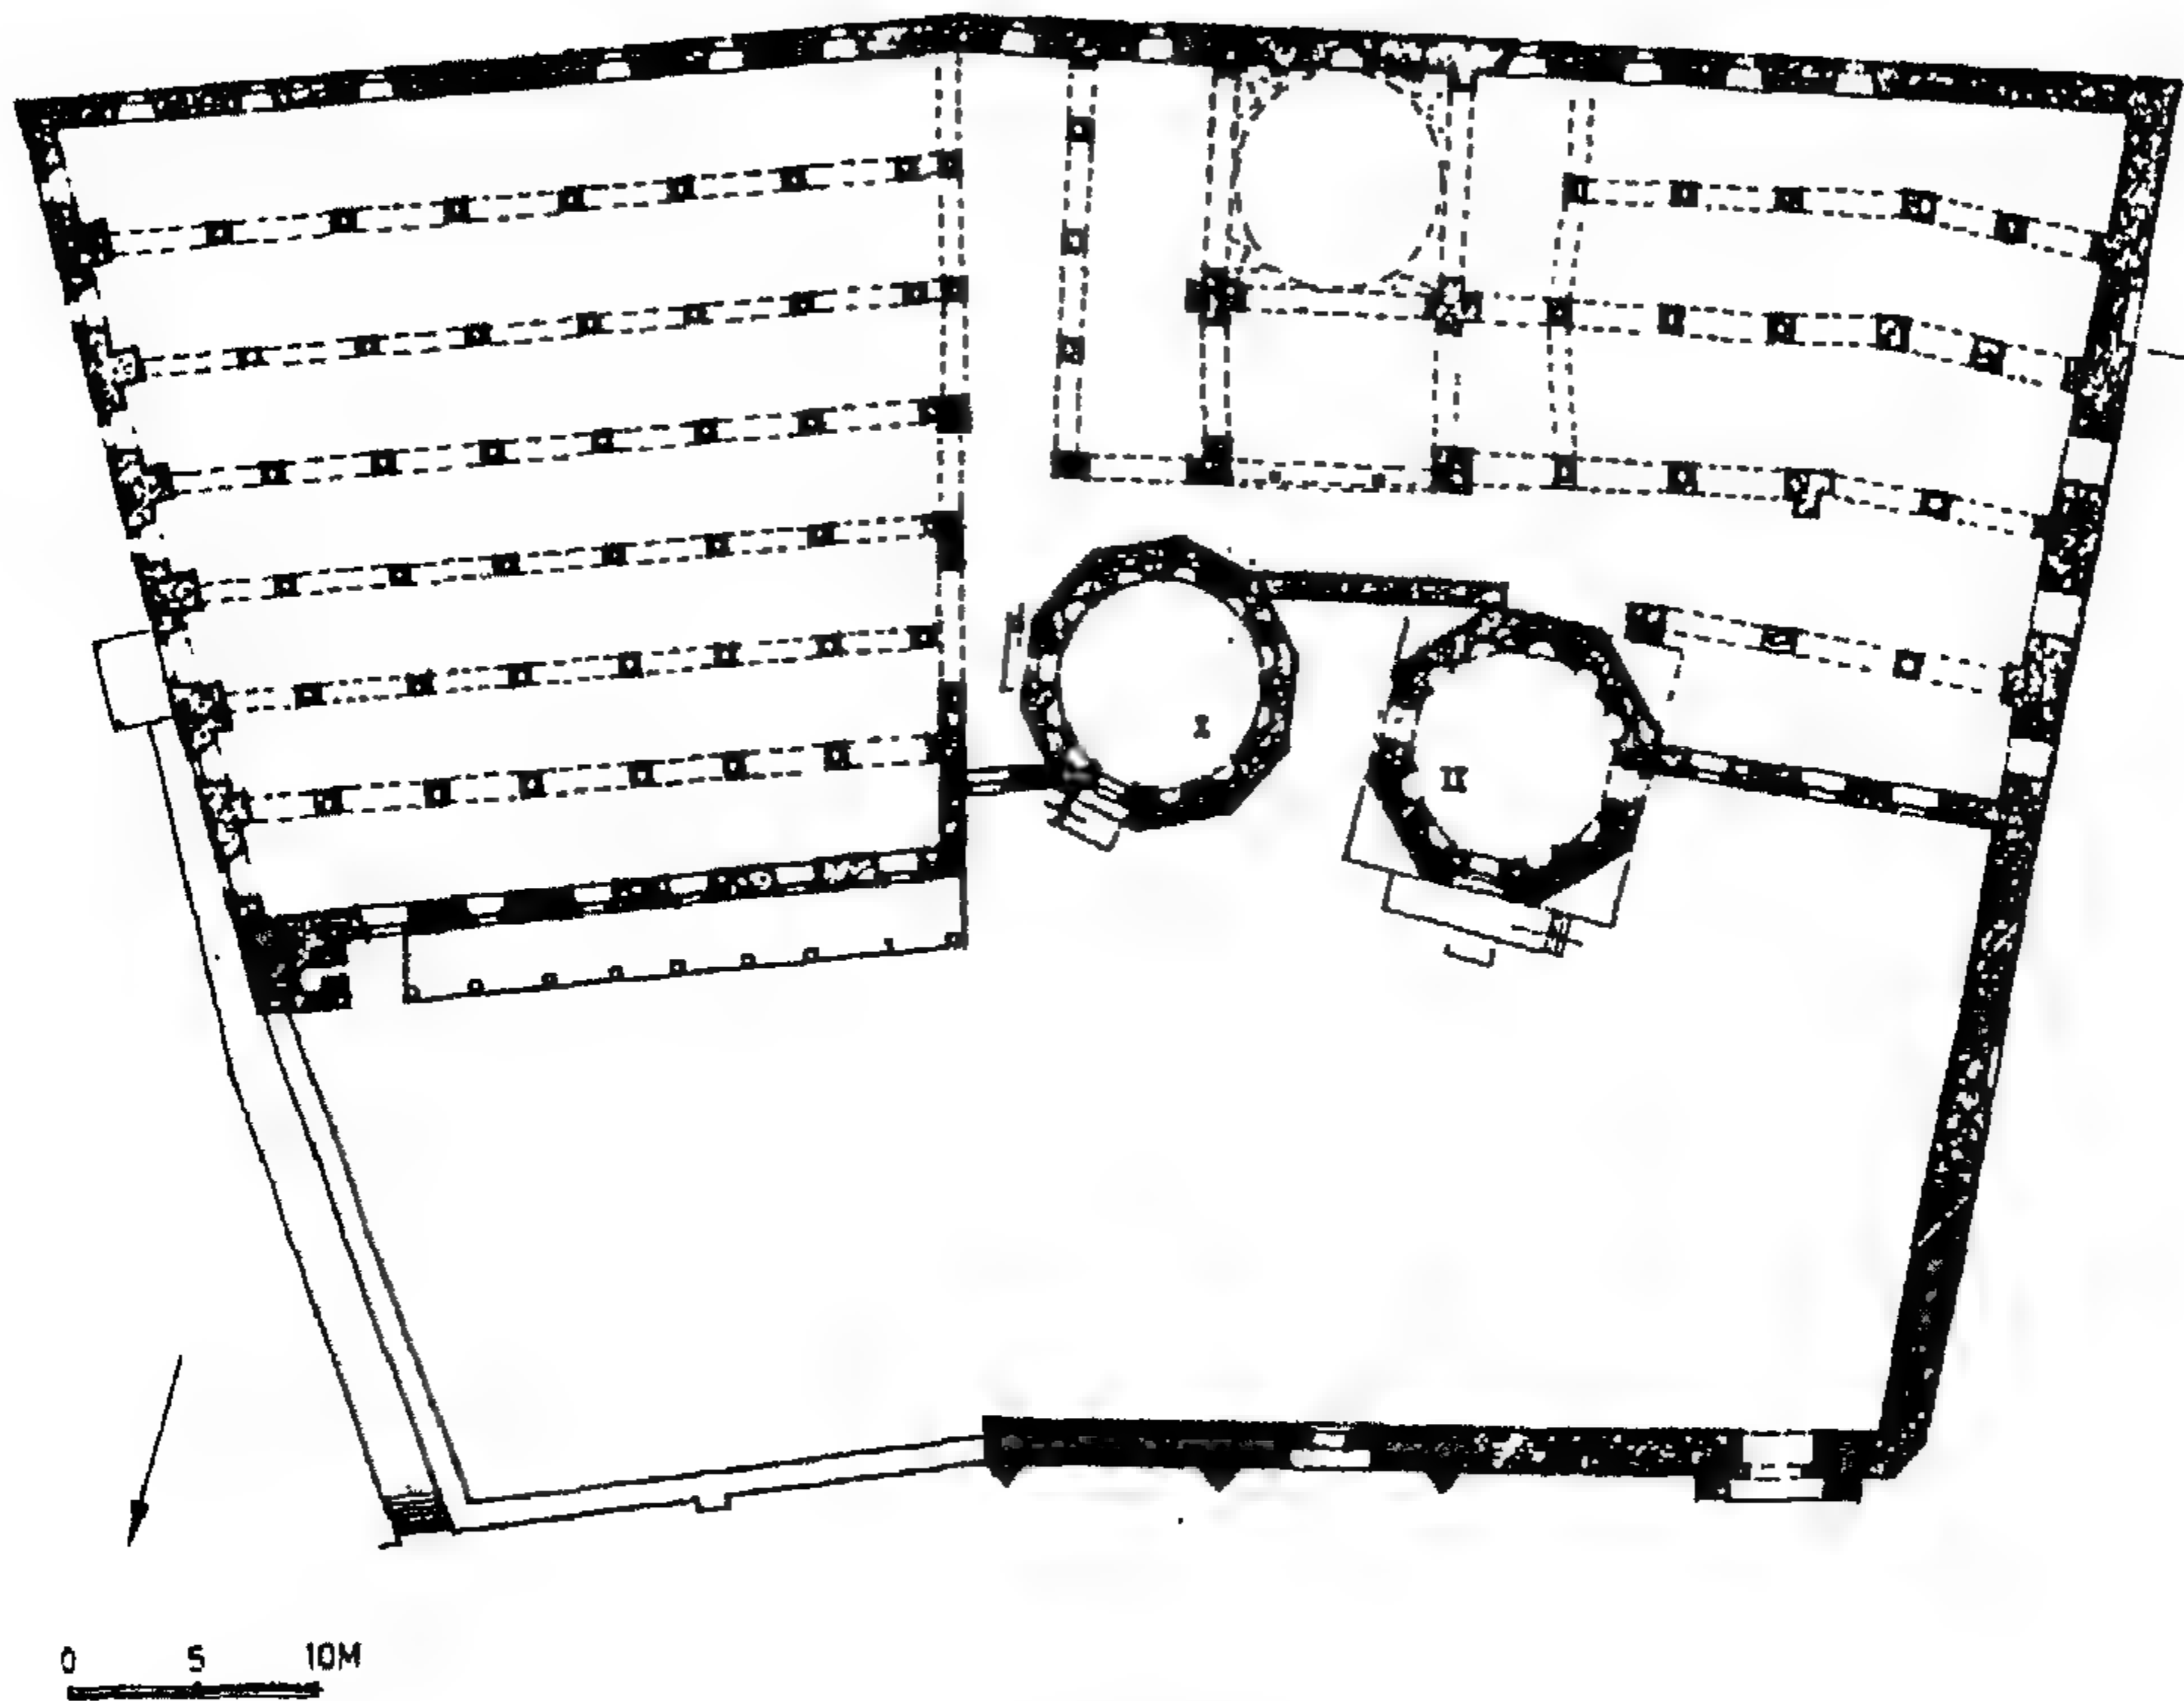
مسقط أفقي للجامع الكبير (اولو جامع) في سيواس (عن : Aslanapa) .
